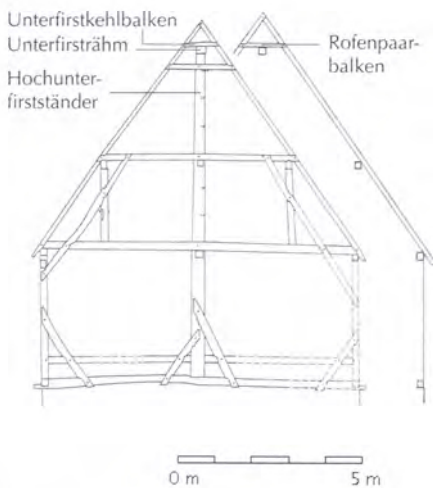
Hochunterfirstständergerüst mit zweifach stehendem Querbund (hier: zweifach stehender Stuhl) im 1. Dachgeschoss und Rofenpaar-balken in den Querbündeln, Stuttgart-Vaihingen, Pfarrhausstr. 17a, 1534 (d).
